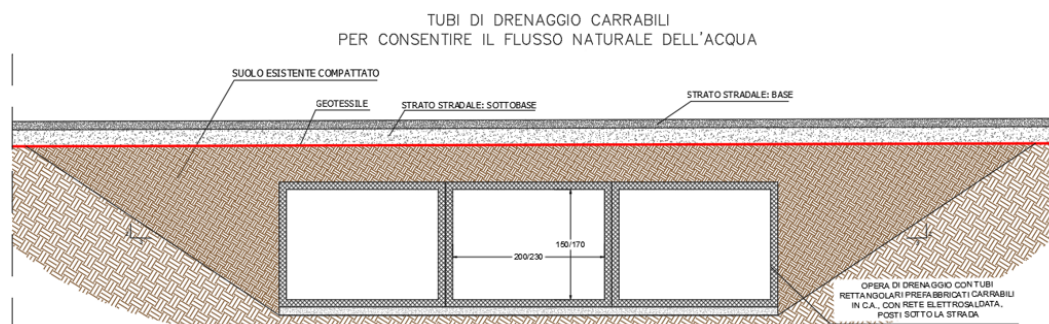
Attraversamenti tipo con tubi a sezione rettangolare, sotto le strade interne d'impianto
